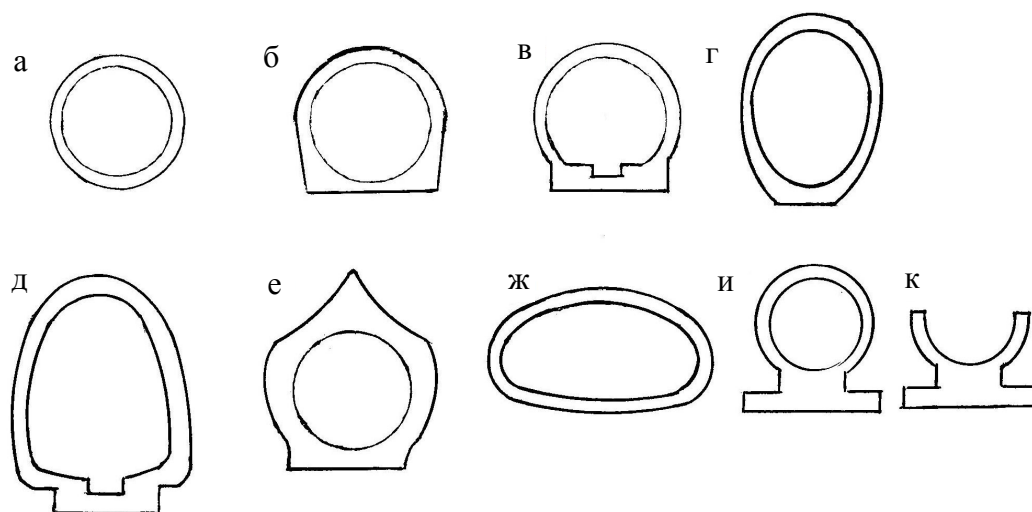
Основные формы поперечного сечения бетонных и железобетонных труб:
